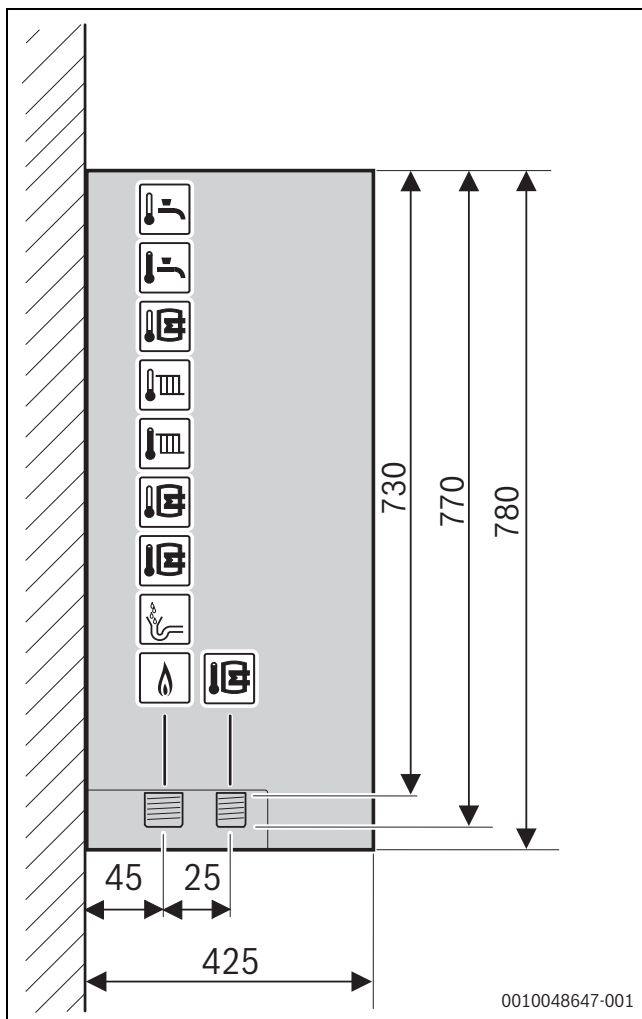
Seitenansicht GB(H)192i.2-30 T40SW H(mm)
